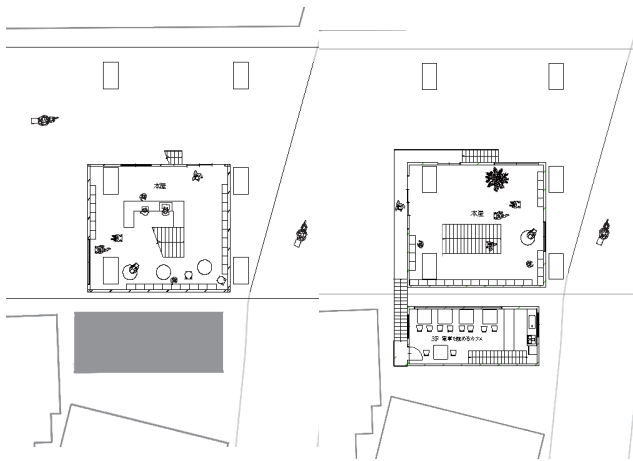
Site2 本屋×カフェ 平面図(左:1F右:2F)
